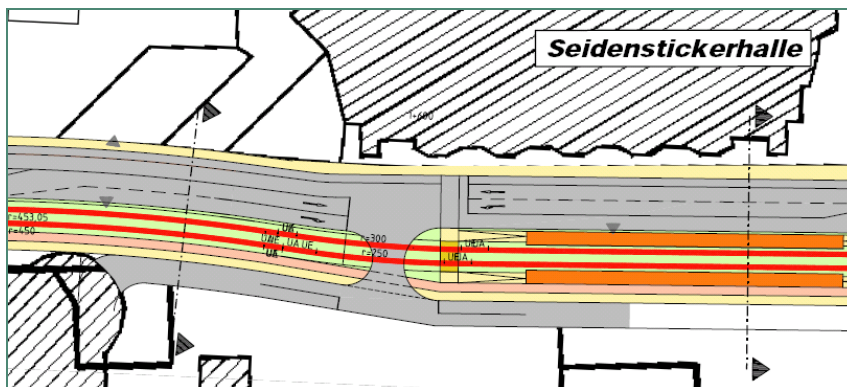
Werner-Bock-Straße mit Haltestelle Seidenstickerhalle
